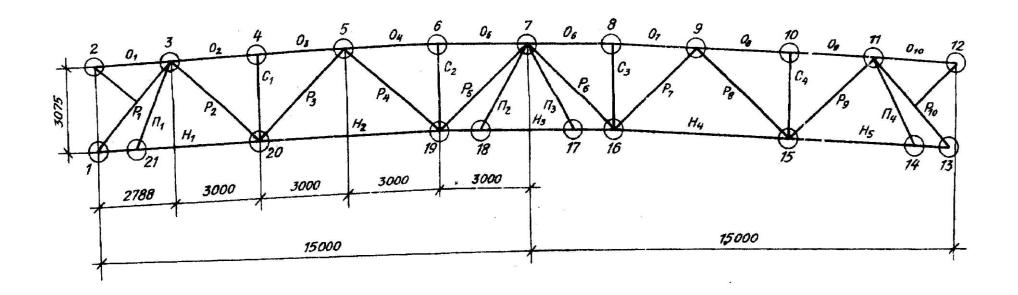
Геометрическая схема фермы IV – Φ C 30 – 3, 15 В
